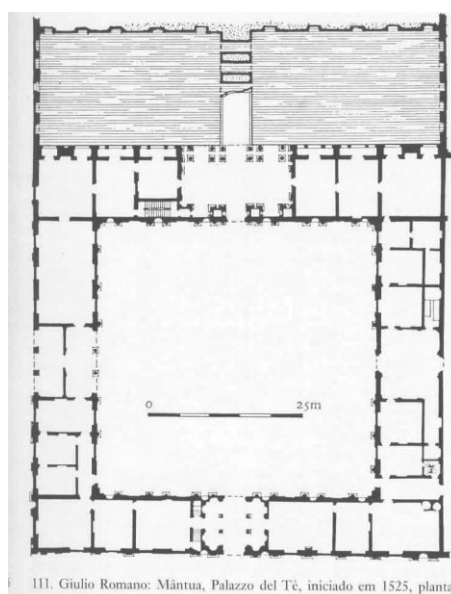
Planta baixa Pallazo del Te - Giulio Romano - Fonte: Lotz, 1998.
